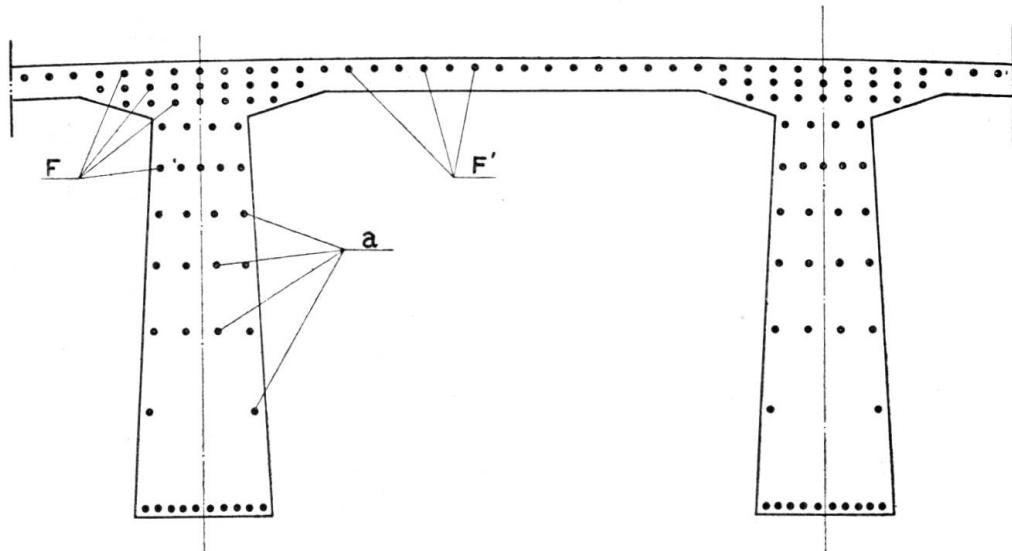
Esquema da distribuição das armaduras nas zonas dos apoios das vigas contínuas, em «T»
